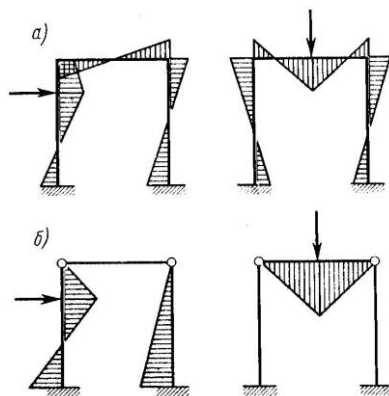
Эпюры моментов в поперечной раме при жестком (а) и шарнирном (б) соединении ригелей с колоннами
